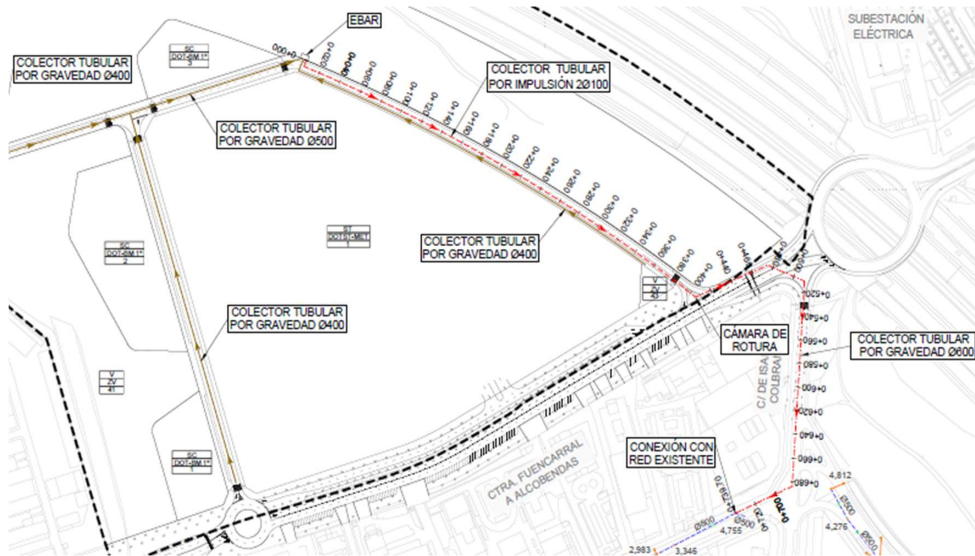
Planta de la red de recogida de aguas residuales. alternativa con EBAR. Solución elegida
